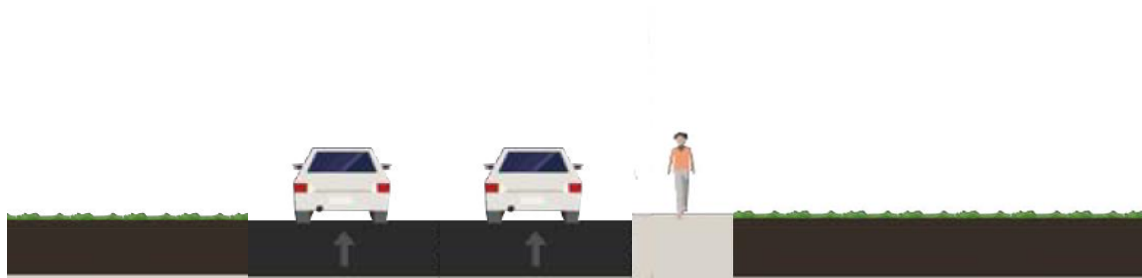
Secció F-F’, rotonda entre carrer Santa Anna i carrer Sant Jaume.
